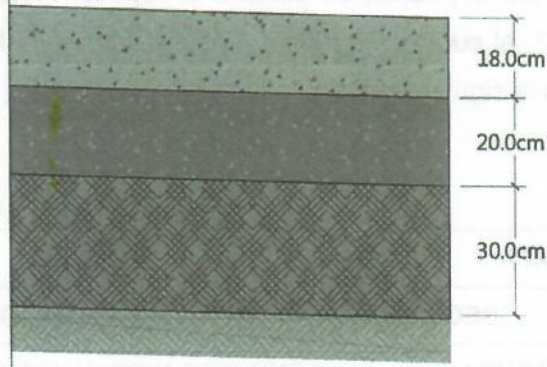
Sección propuesta para la sección 1 (rampas de aproximación) – Pavimento rígido
